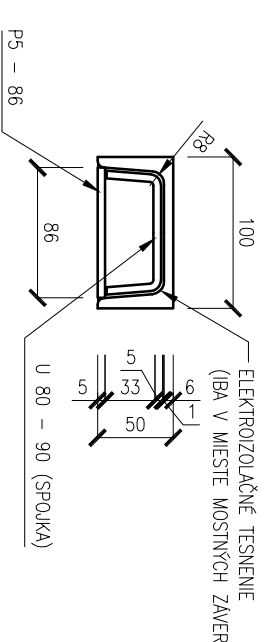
DETAIL ÚCHYTU ZÁBRADLIA M 1:5
